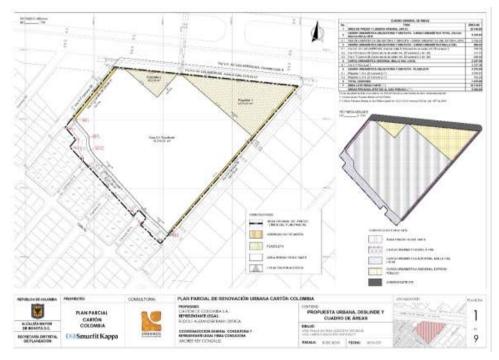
Planteamiento urbanístico del PPRU Cartón Colombia, Plano 1/9. Fuente: Elaboración propia
